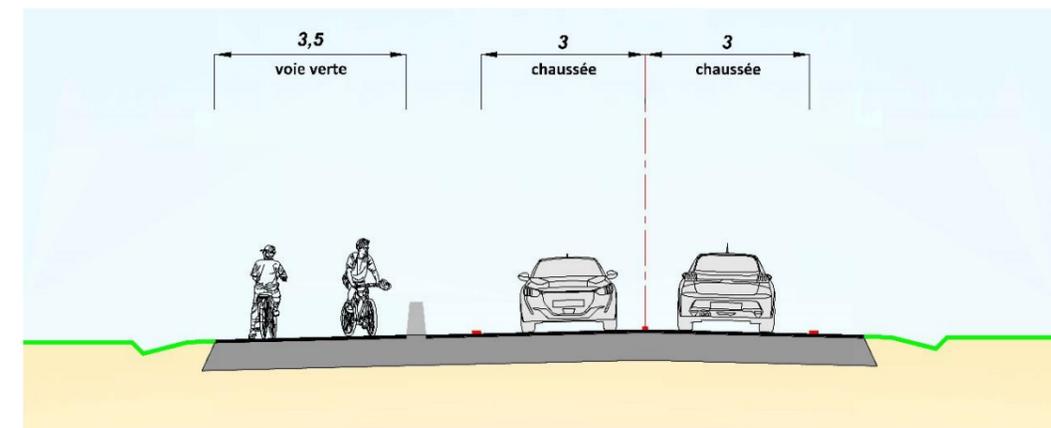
Profil en travers de la voie verte entre St-Gilles et Agneaux
